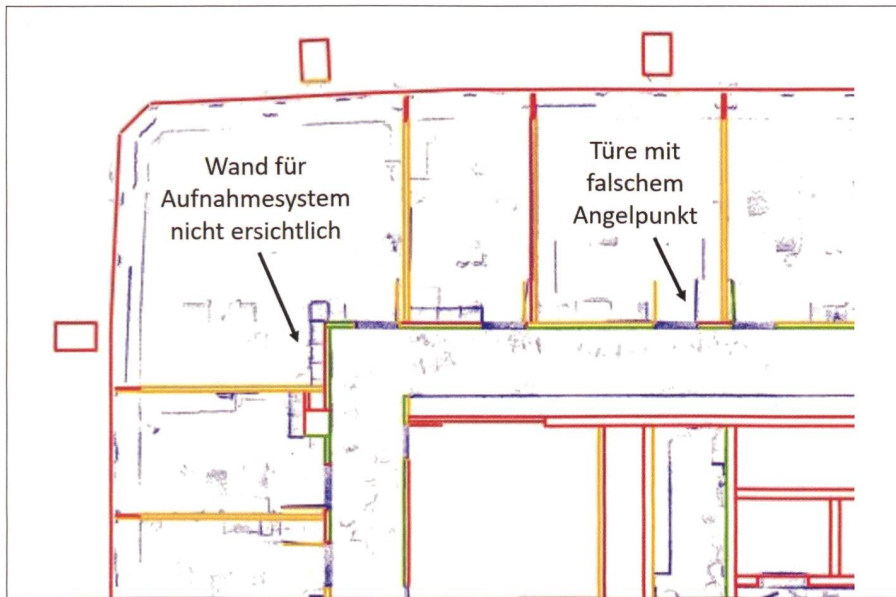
Ausschnitt aus dem Gebäudeplan mit den klassifizierten Geometrien.
